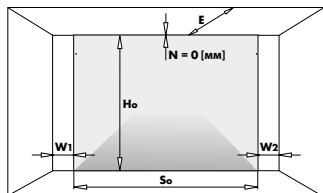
Монтажные размеры, необходимые для правильного выбора и установки подвесных откатных ворот – монтаж к потолку.
